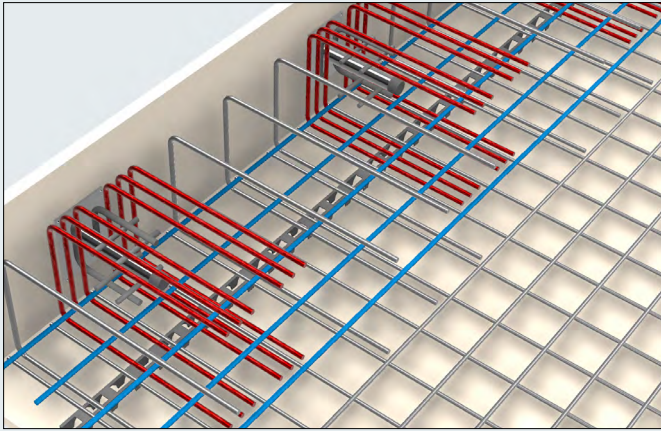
Querkraftdornhülsen anordnen, untere Bewehrungslage und Bügel verlegen (Abstände beachten).
